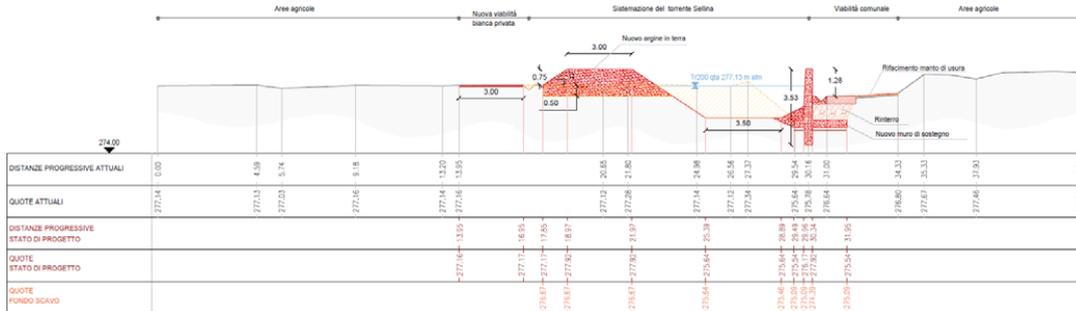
estratto della tavola T03a del progetto - Sezione 2432.
